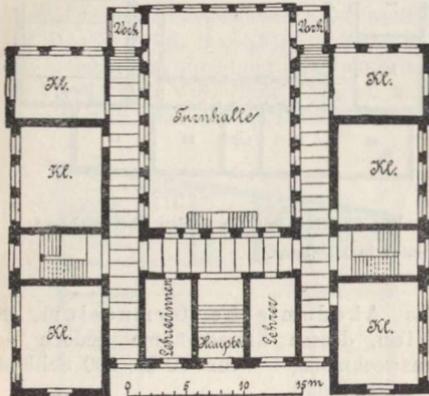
Grundriß vom Erdgeschoß der Mädchen-Mittelschule in Darmstadt.
